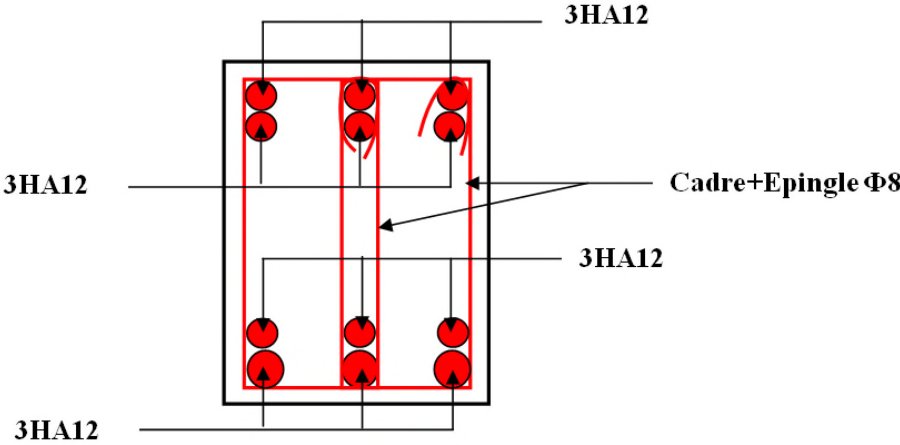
schéma de ferrailage de la poutre palière étage courant
